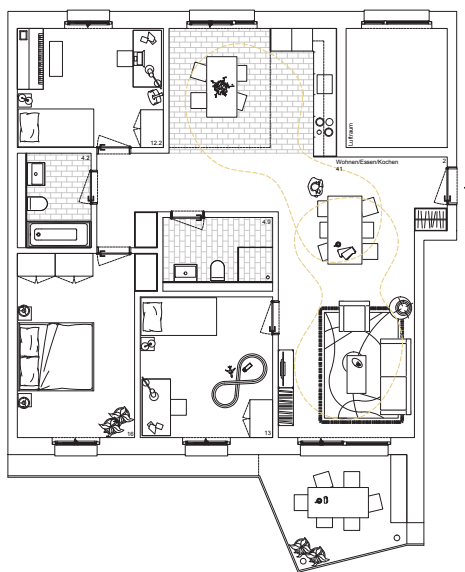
sobremesa: 4.5-Zimmer Wohnung, Haus zum Park und Entlisberg
